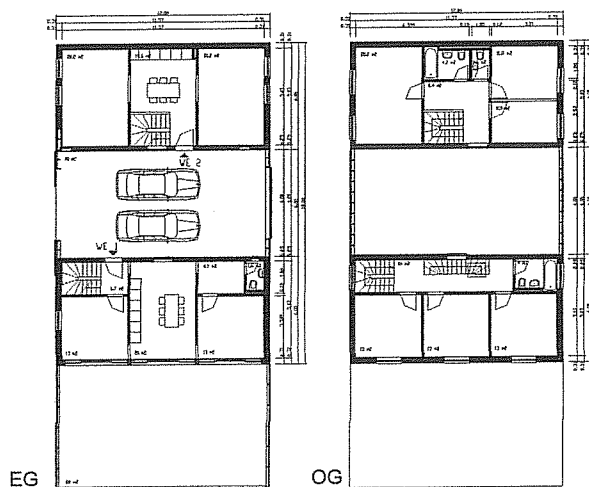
Grundrisse Erd- und Obergeschoss mit Gartenhof und Tenne⁸
